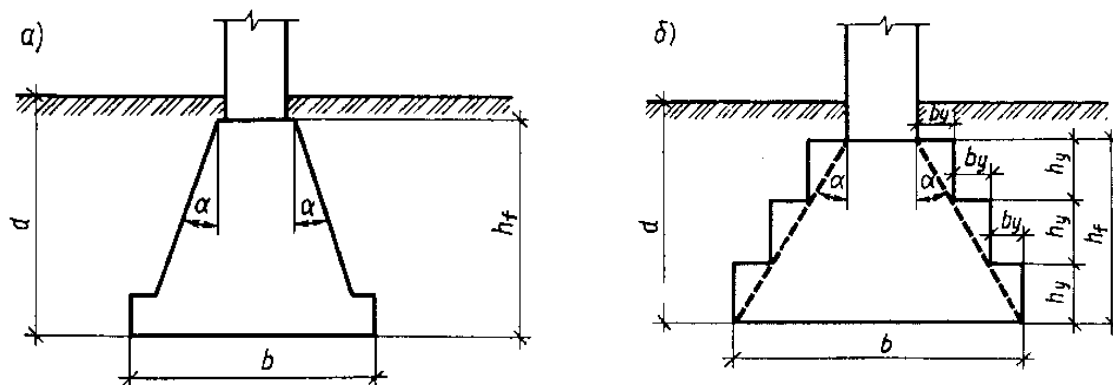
Конструкция отдельного фундамента под колонну:
